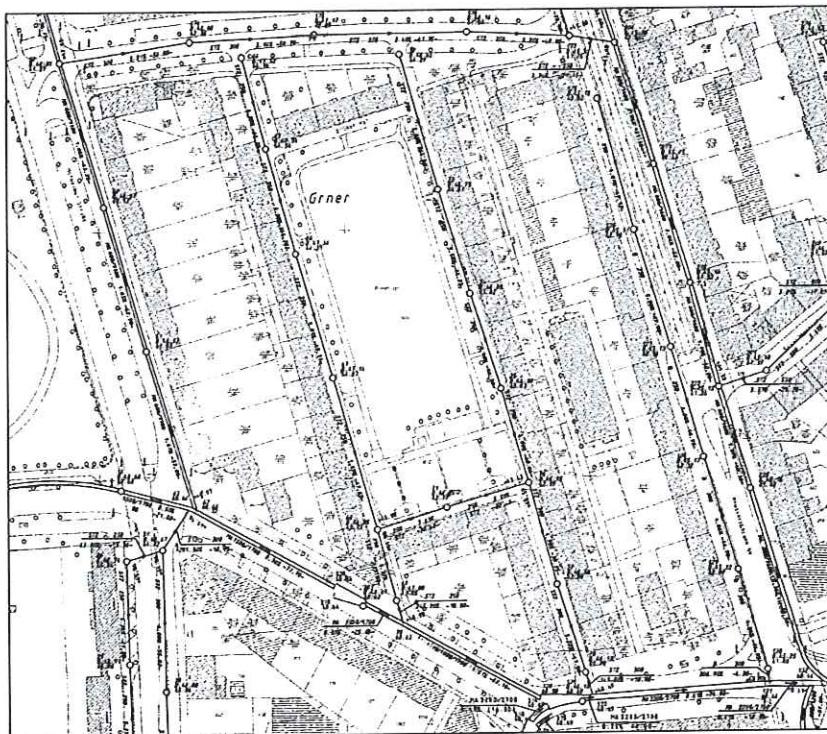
Lageplan des Sanierungsobjektes in Köln
